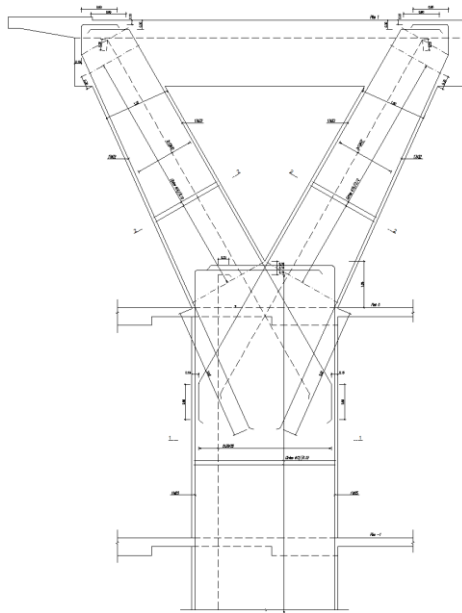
Alçado de armaduras dos pilares em V entre o piso -1 e o piso 1.
